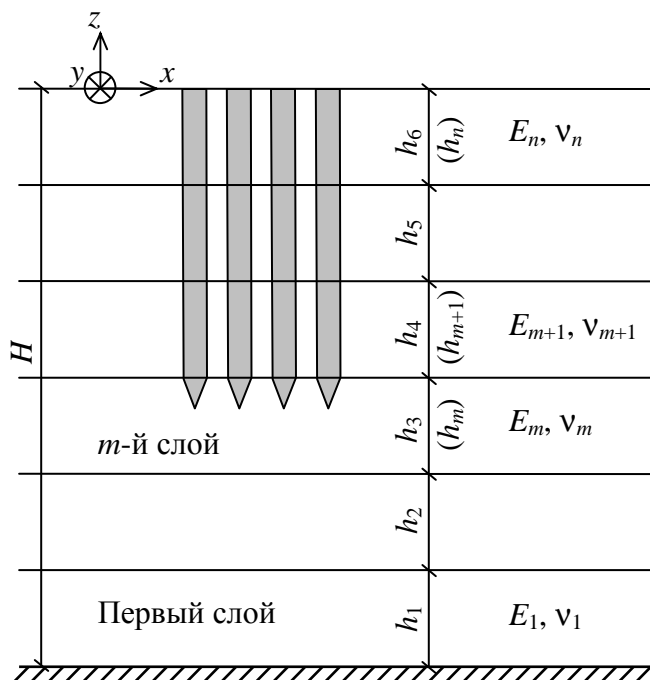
Свайное основание. E_i, ν_i — модуль деформации и коэффициент Пуассона i -го слоя грунта
